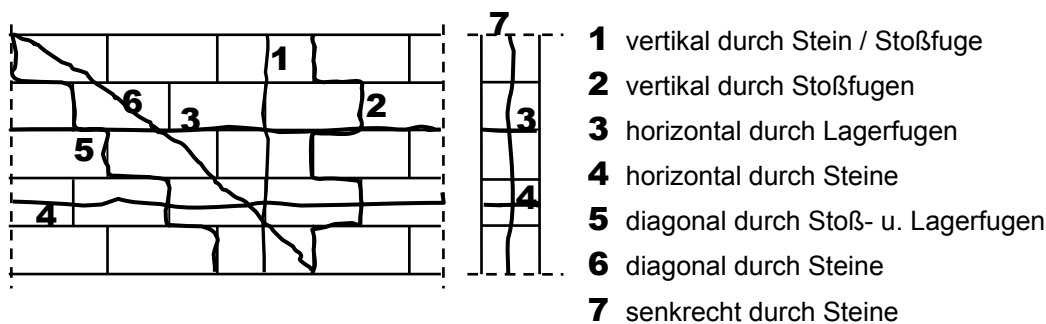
Typische Rissarten in Mauerwerk
